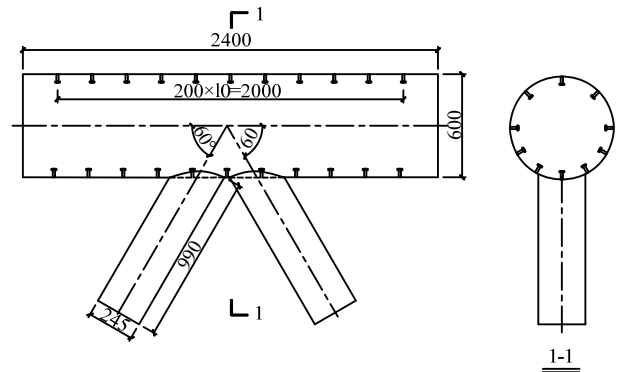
钢管混凝土 K 形内栓钉节点试件构造图 /mm
